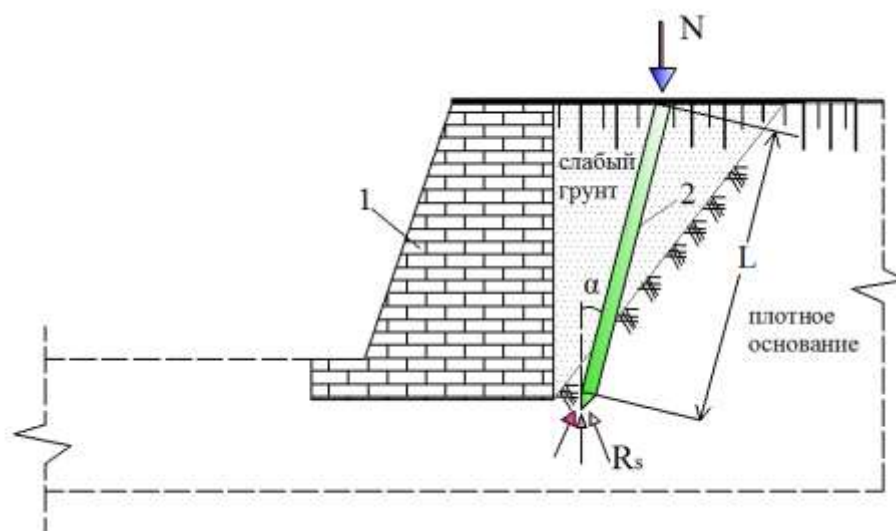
Укрепление грунтового слоя перед береговой опоры сваями-стойками
